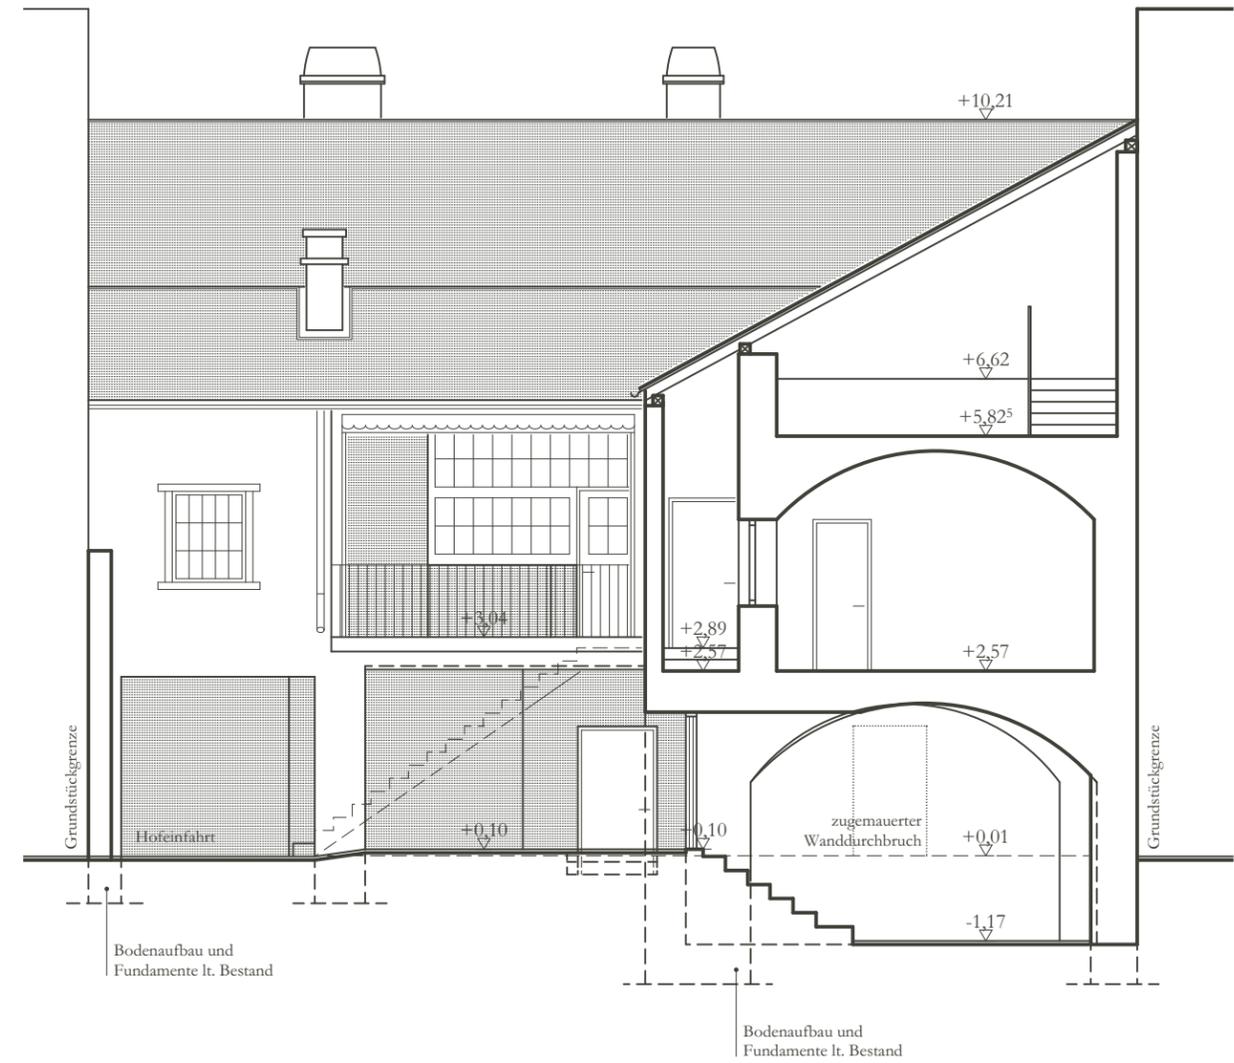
Bestandsplan Schnittansicht B-B, M 1:100
